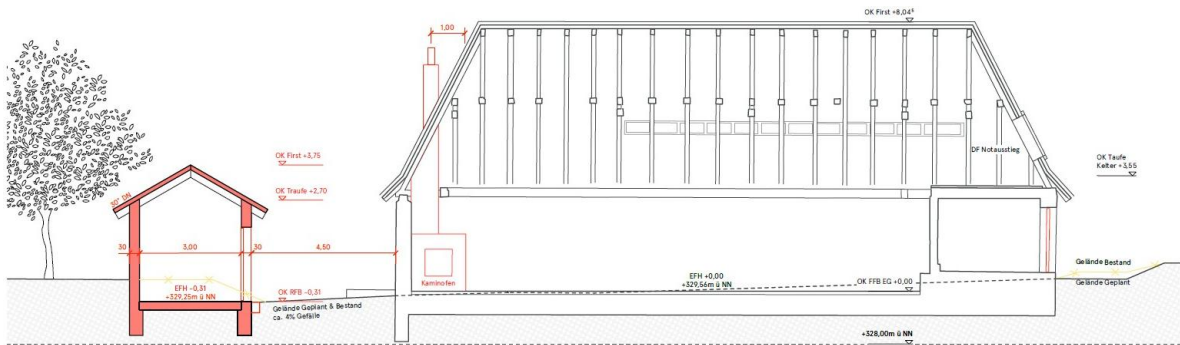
Längsschnitt Umnutzung einer alten Kelter zur Veranstaltungsstätte – Planverfasser Patrick Seehuber 31.03.2025
